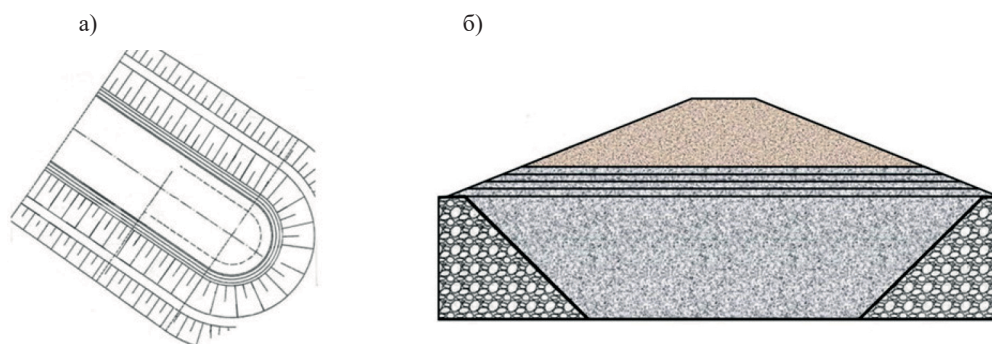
Защитная дамба гидроузла «Руппур»: а — план; б — поперечный разрез
